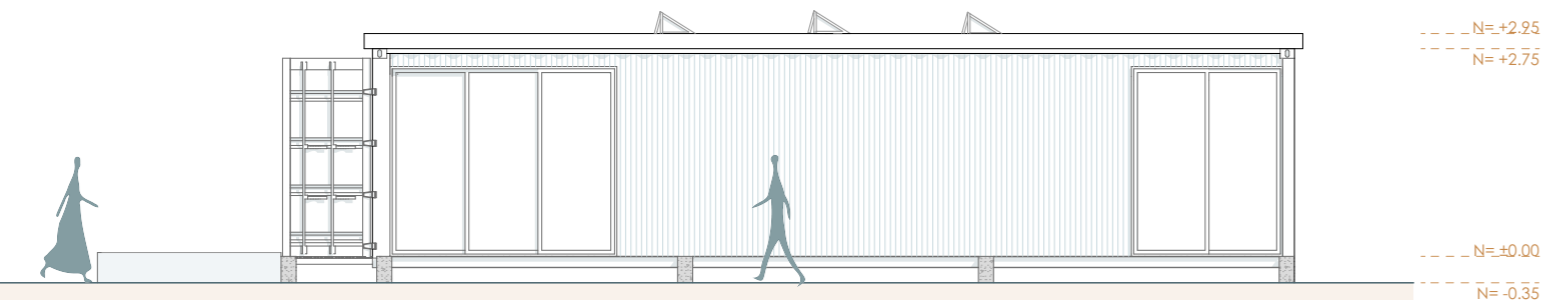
Elevación lateral derecha vivienda tipo 1.
